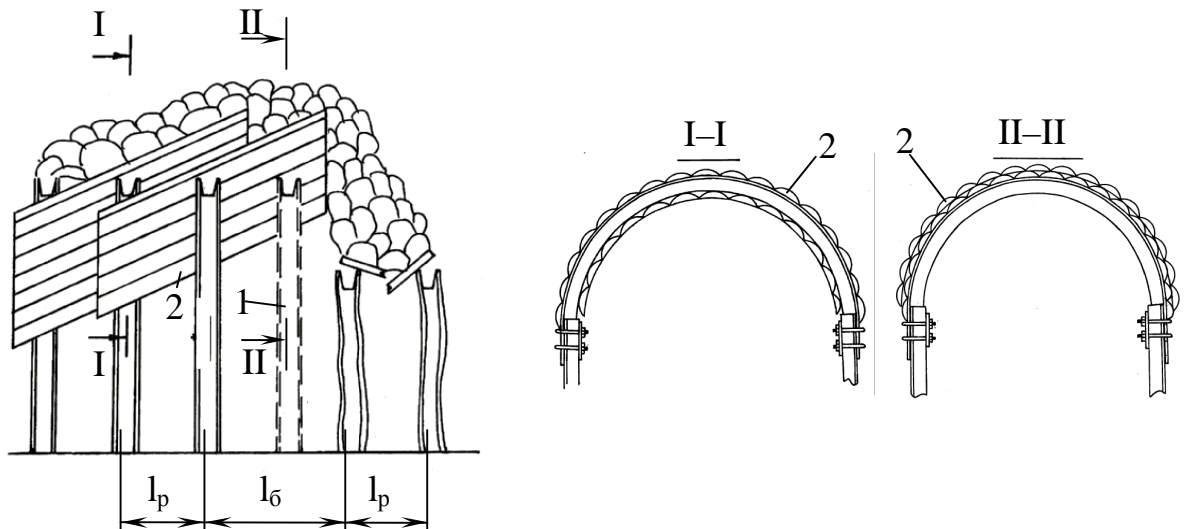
Схема установки деревянных кольев (шильев) при замене арочной крепи в перекрепляемой выработке: 1 – устанавливаемая рама арочной крепи; 2 –деревянные колья (шилья)
